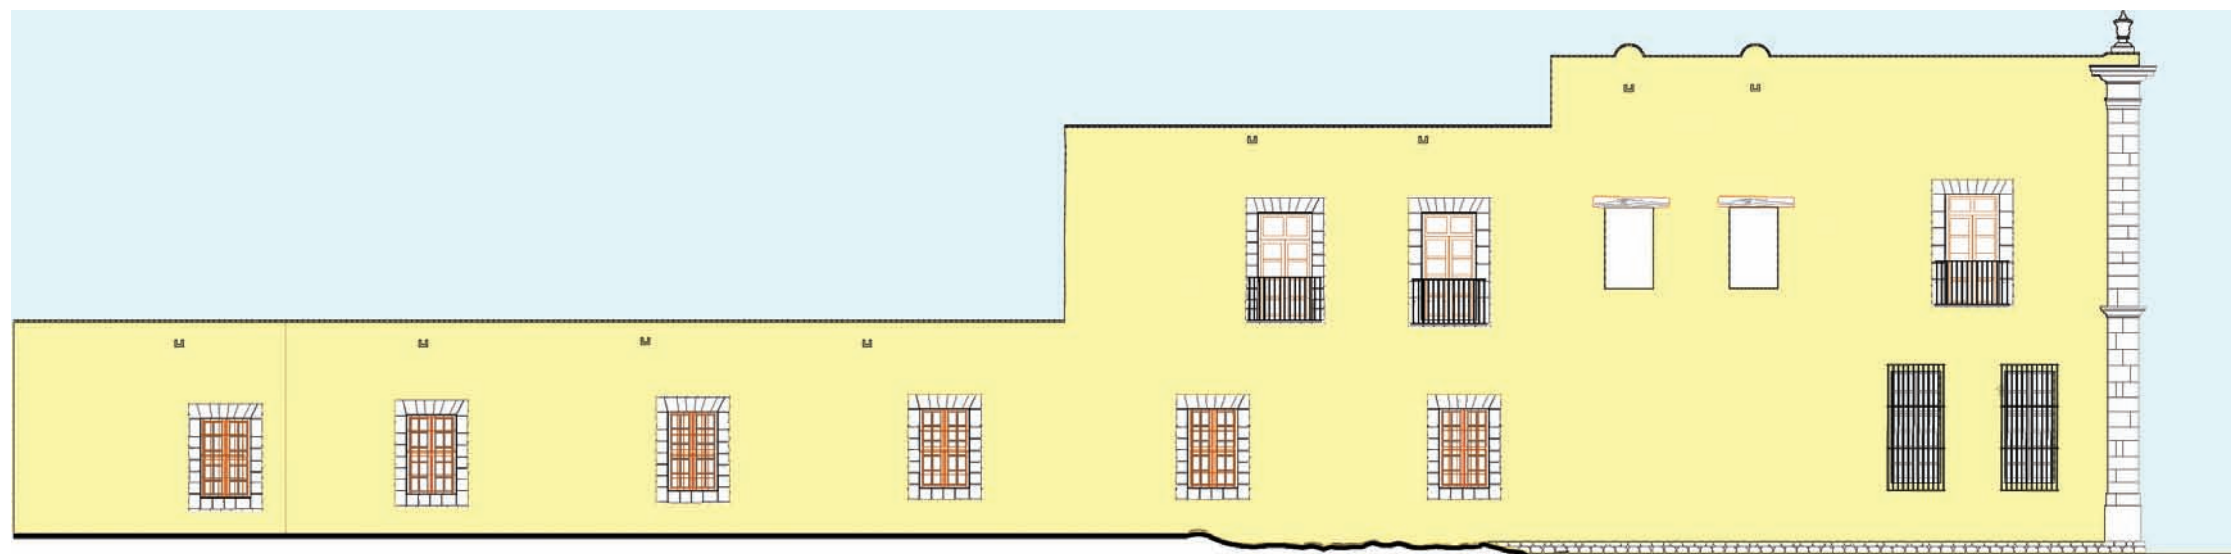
Propuesta de Restauración / Fachada Norponiente
